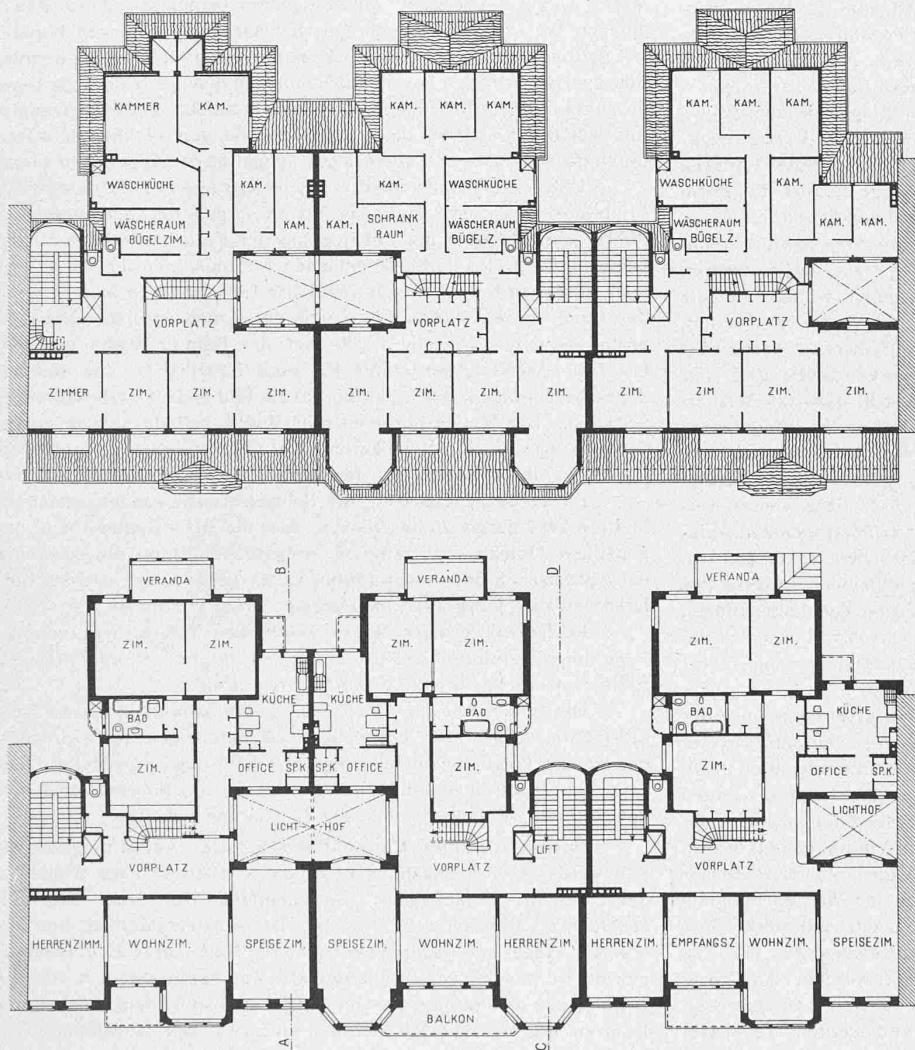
und 6. Grundrisse vom III. Obergeschoss und Dachgeschoss. — 1 : 400.
